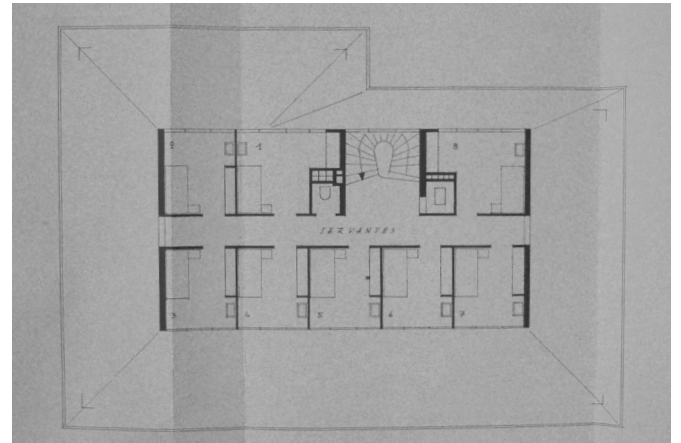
Grundriss, Dachgeschoss mit acht Mansarden (1954)
